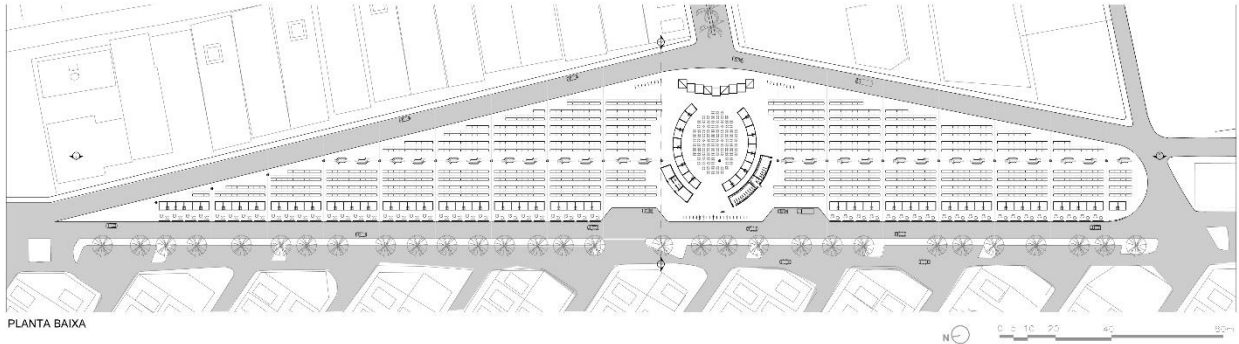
Planta baixa Sexta-Feira. Fonte: Elaboração própria
